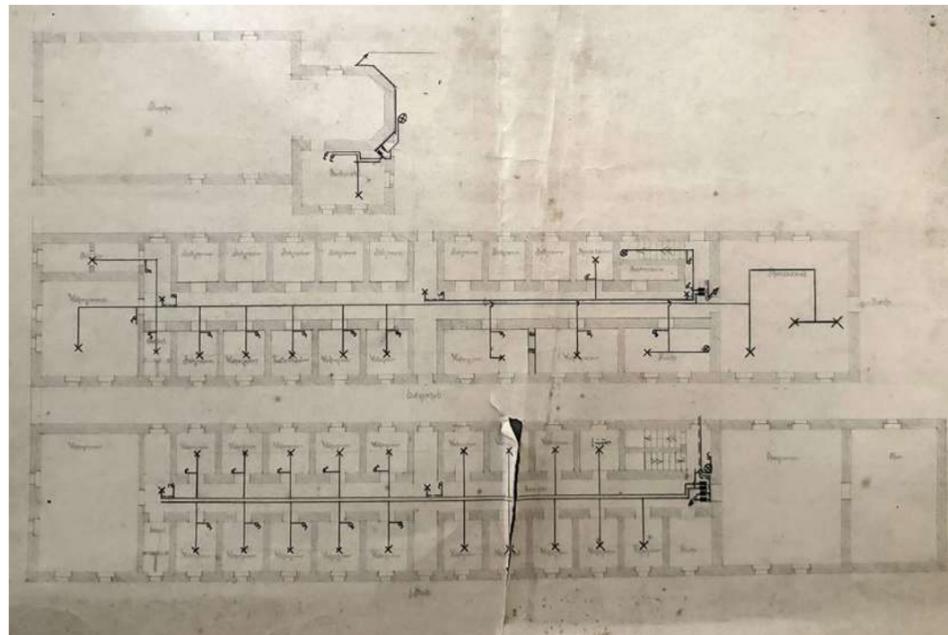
Stadtarchiv Weitra. Grundrisse des Bürgerspitals und der Kirche, um 1902
